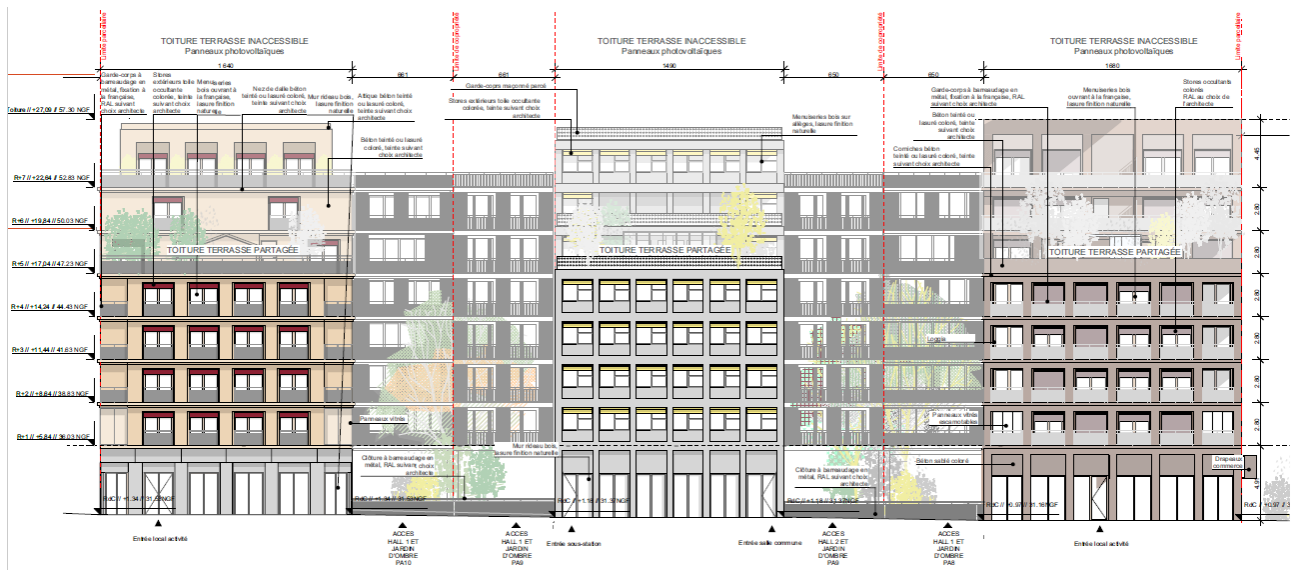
Plan des façades Ouest (source : PC 05.02, 29/06/2020)
